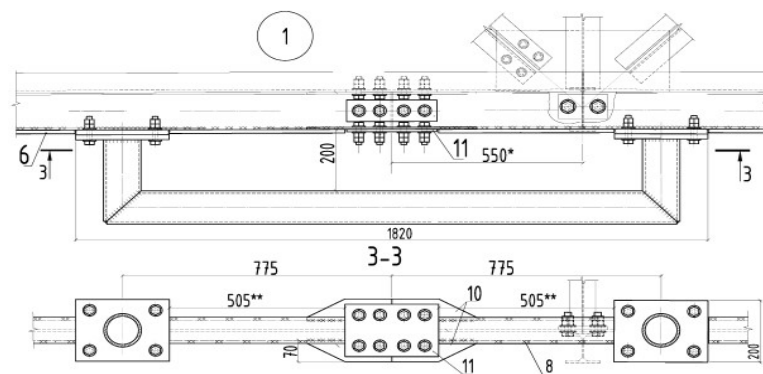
Конструктивне рішення розвантажувальної рами Р-1 у монтажному положенні (фрагмент креслення)
